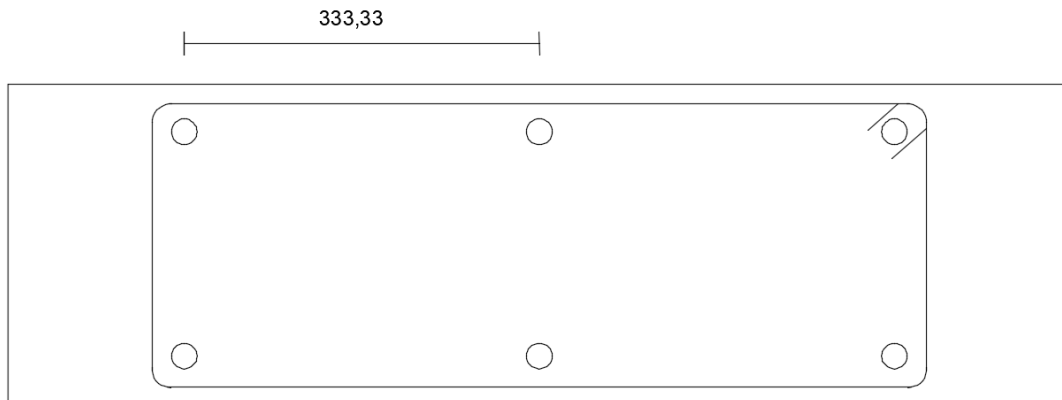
Separación entre barras de acero corrugado. Fuente. Propia.
